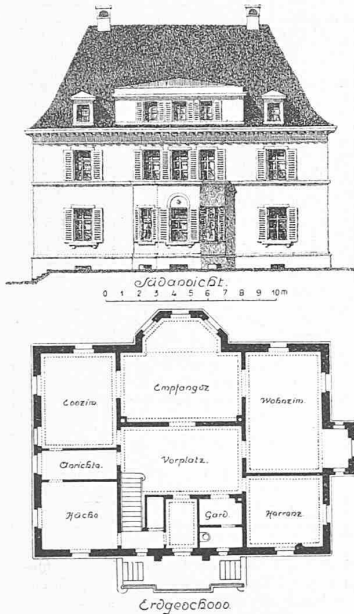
bis 13. Grundriss mit Fassade, 1:400, und West-Ansicht zweier Wohnhäuser an der Kantstrasse. — Architekt Prof. Dr. K. Moser, Zürich.
